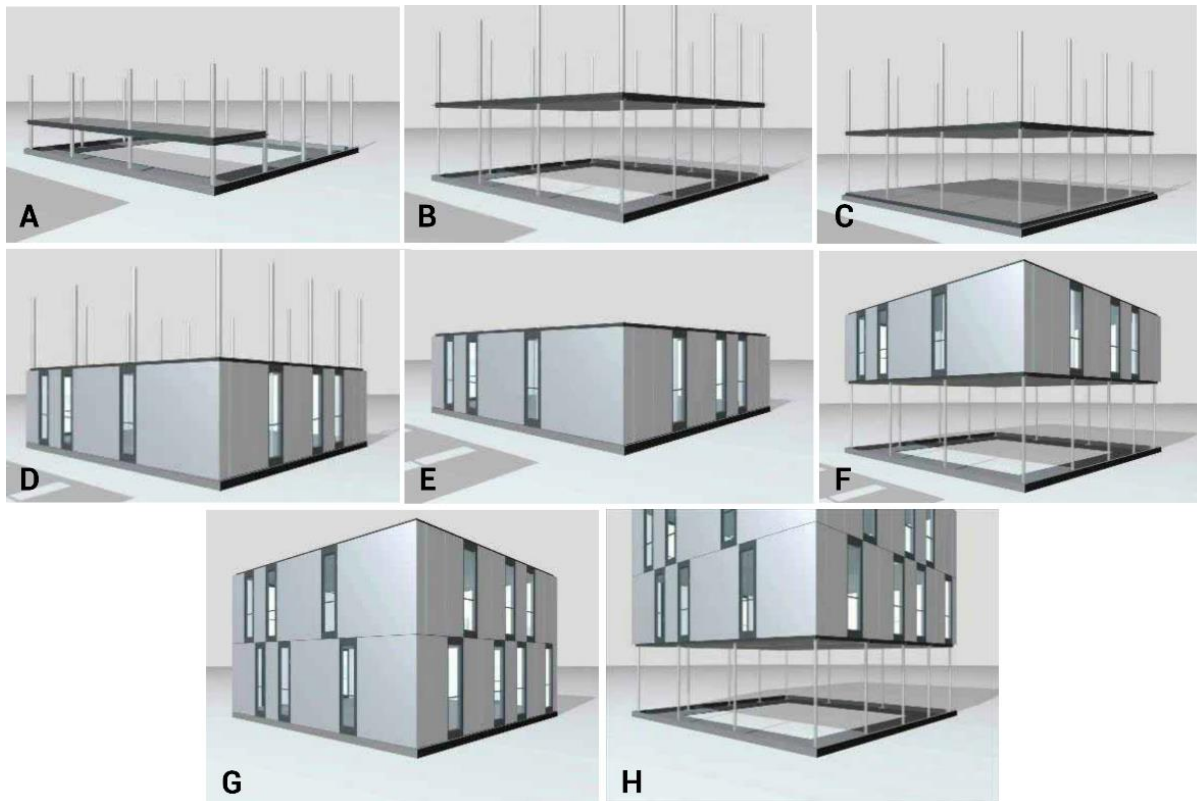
Proceso constructivo de una edificación aplicando el sistema Cotacero. Fuente: Víctor Hermo Sánchez.
